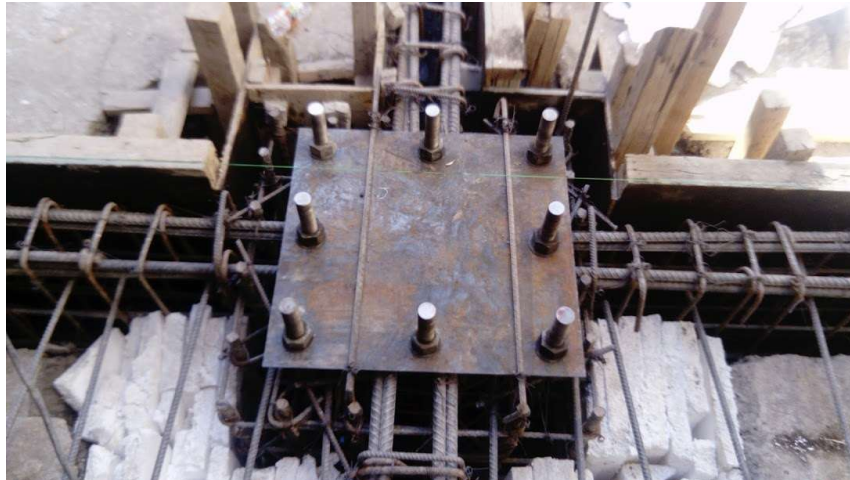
Colocación de plantilla y anclas, fijándolas mediante soldadura al armado del dado, para que al momento del vibrado del concreto estos no presenten desplazamientos.
